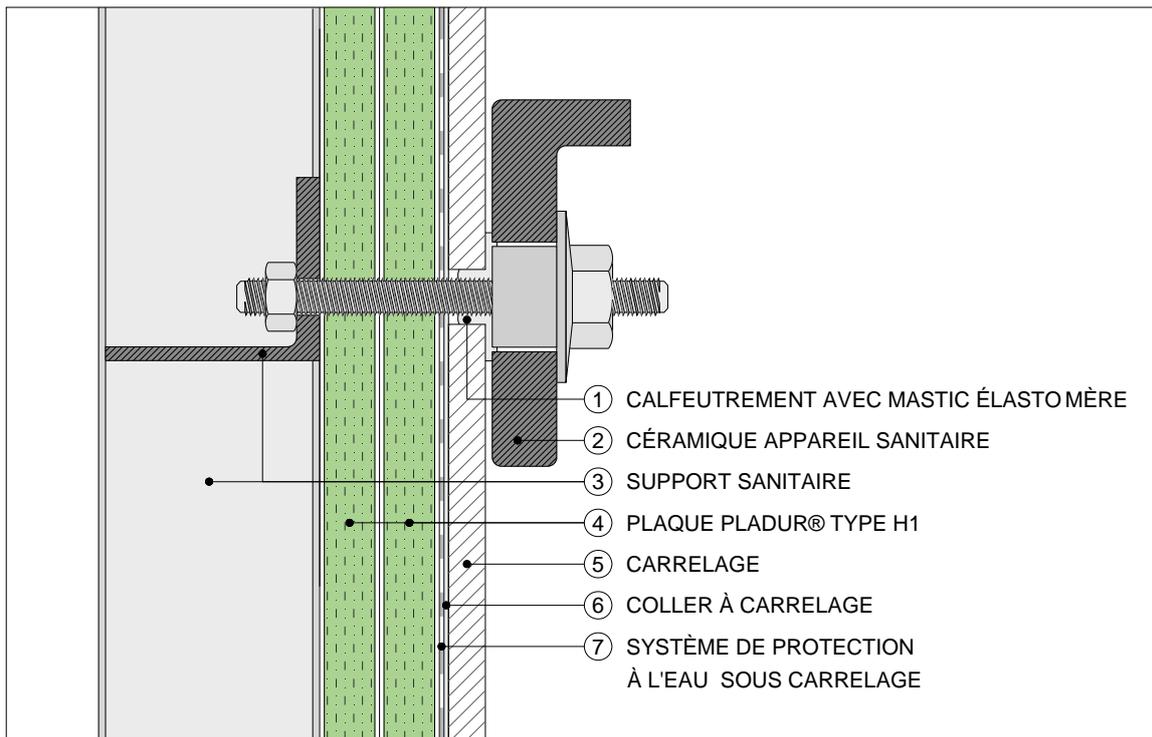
Traitement de la fixation d'un appareil sanitaire – Coupe verticale (Cf. article 7)
